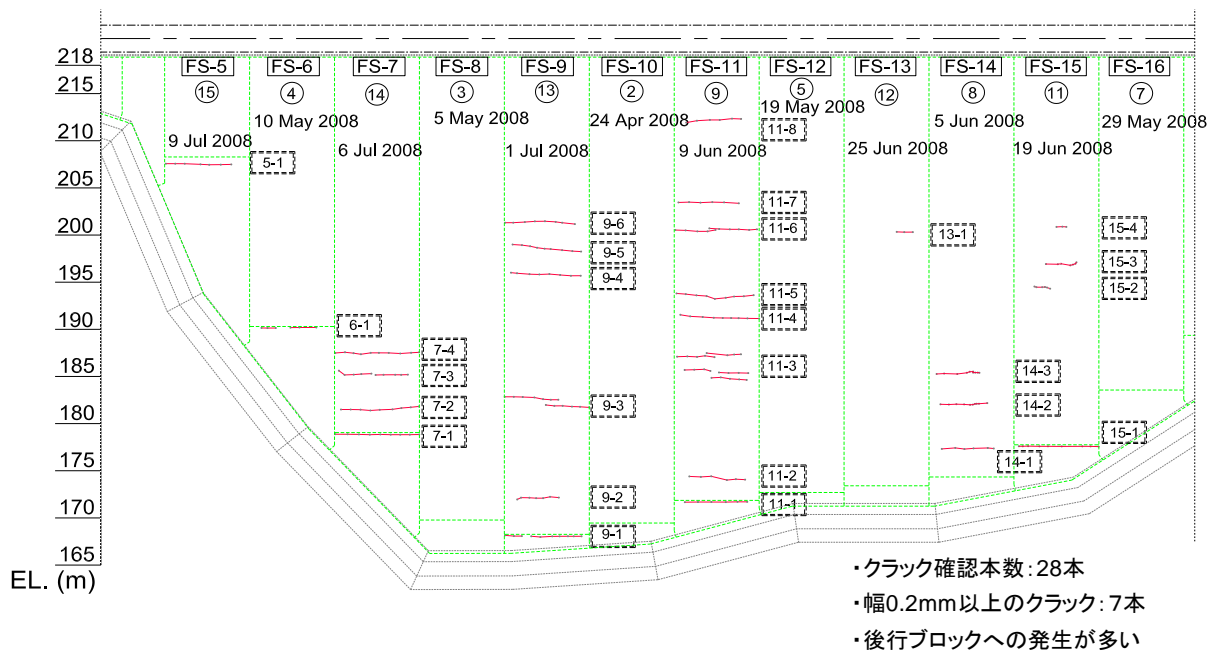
既設ダムでのひび割れ発生状況（ポンレポンレダム・インドネシア）
